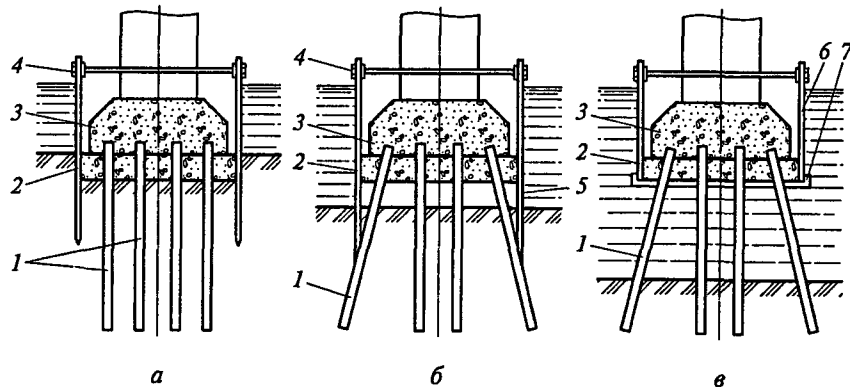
Схемы сооружения монолитной плиты свайных ростверков:
